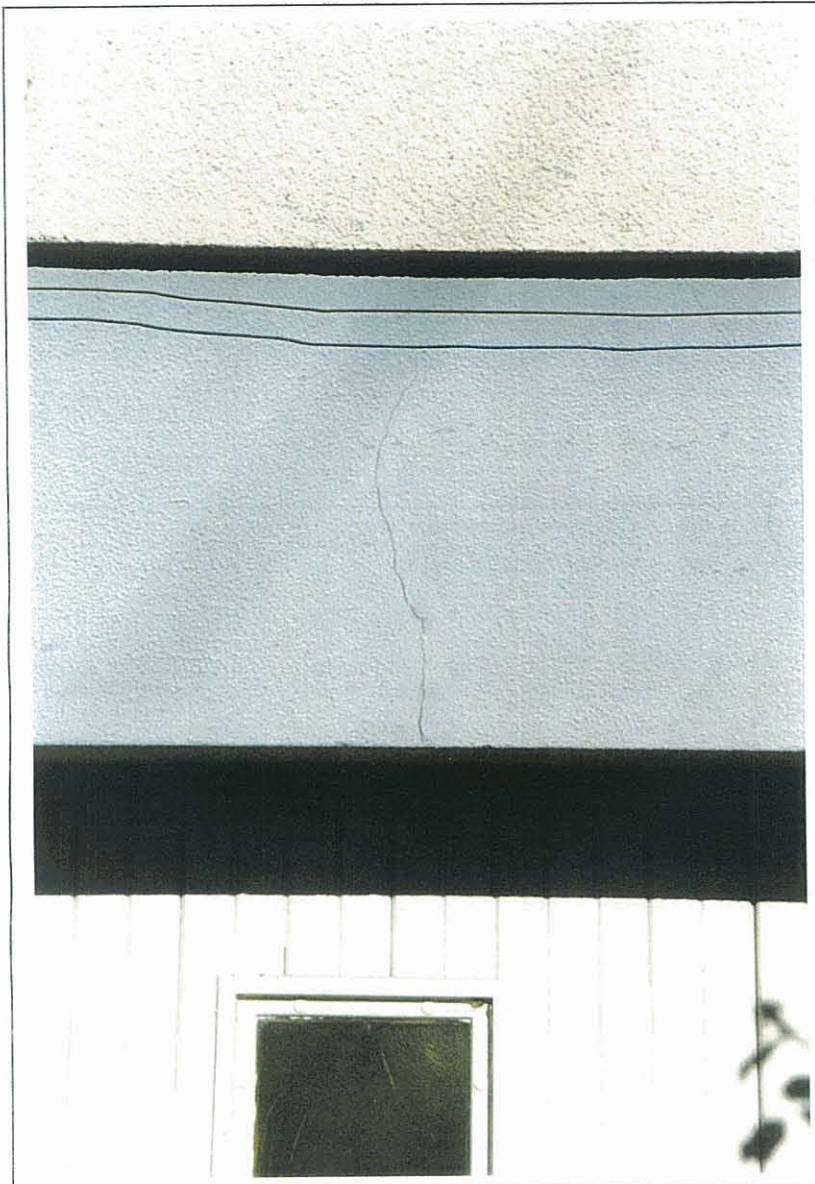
Fissuration du linteau de la porte du garage.
